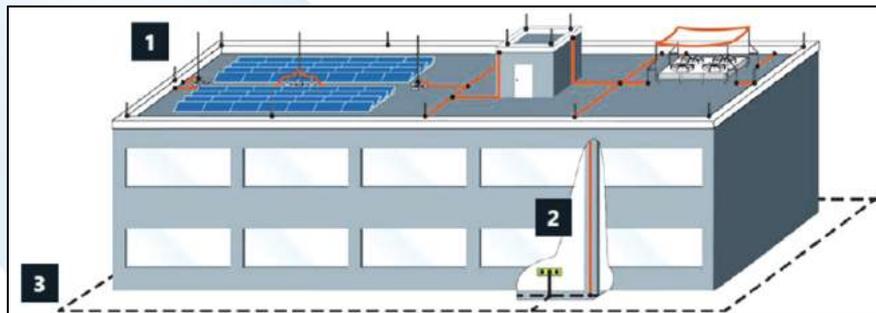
Instalación fotovoltaica en el edificio sin protección, donde: 1. Sistema de terminación de aire; 2. Conductor de bajada; 3. Sistema de terminación de tierra
